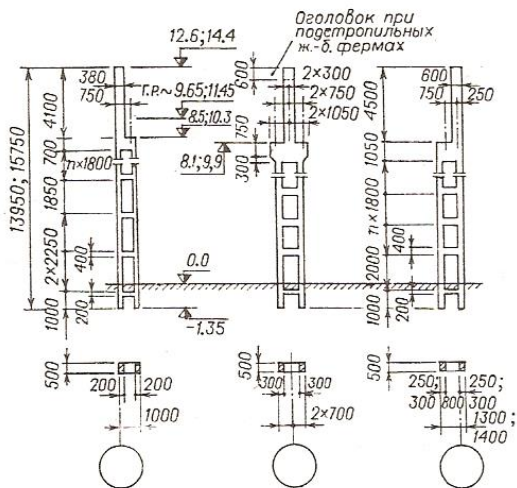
Типы двухветвевых железобетонных колонн для зданий с мостовыми опорными кранами
